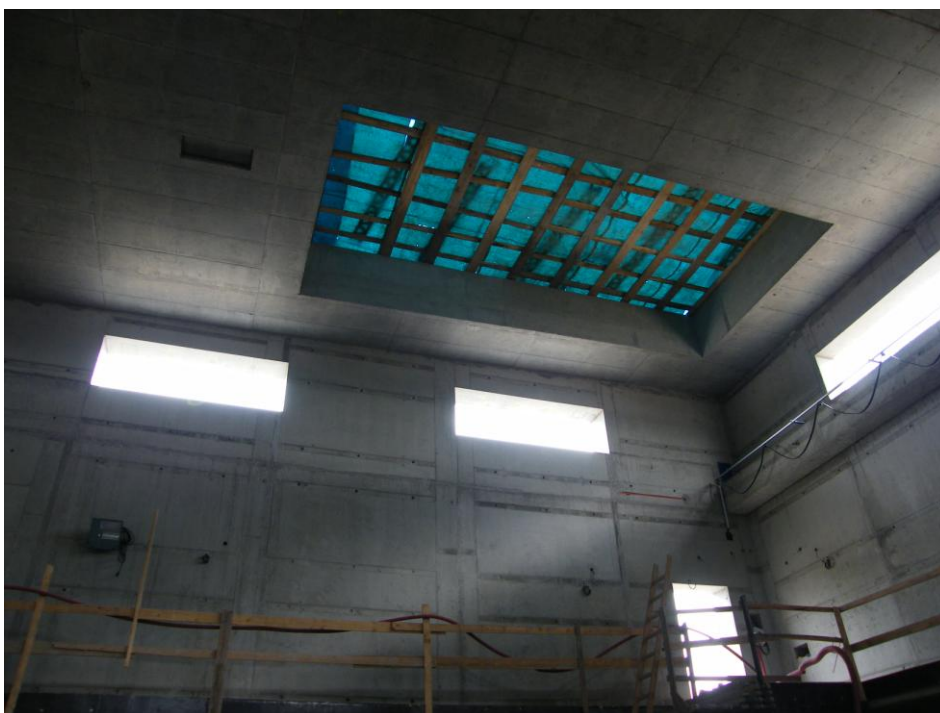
Horní stavba – pohled ze strany vtoku (foto autor)
